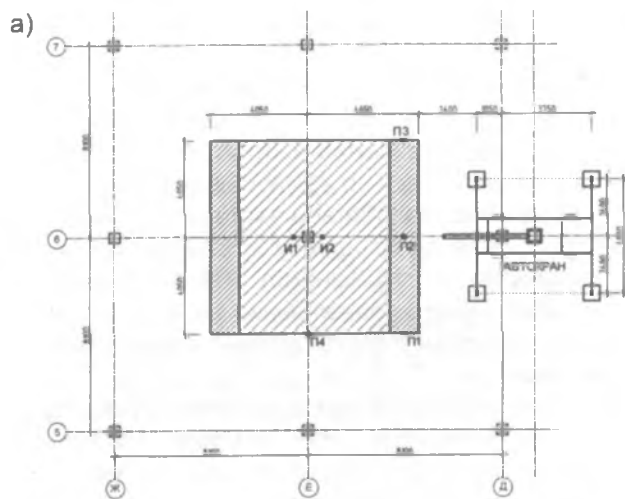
Схема приложения нагрузки при натуральном испытании узла опирания монолитной плиты покрытия подземного гаража
